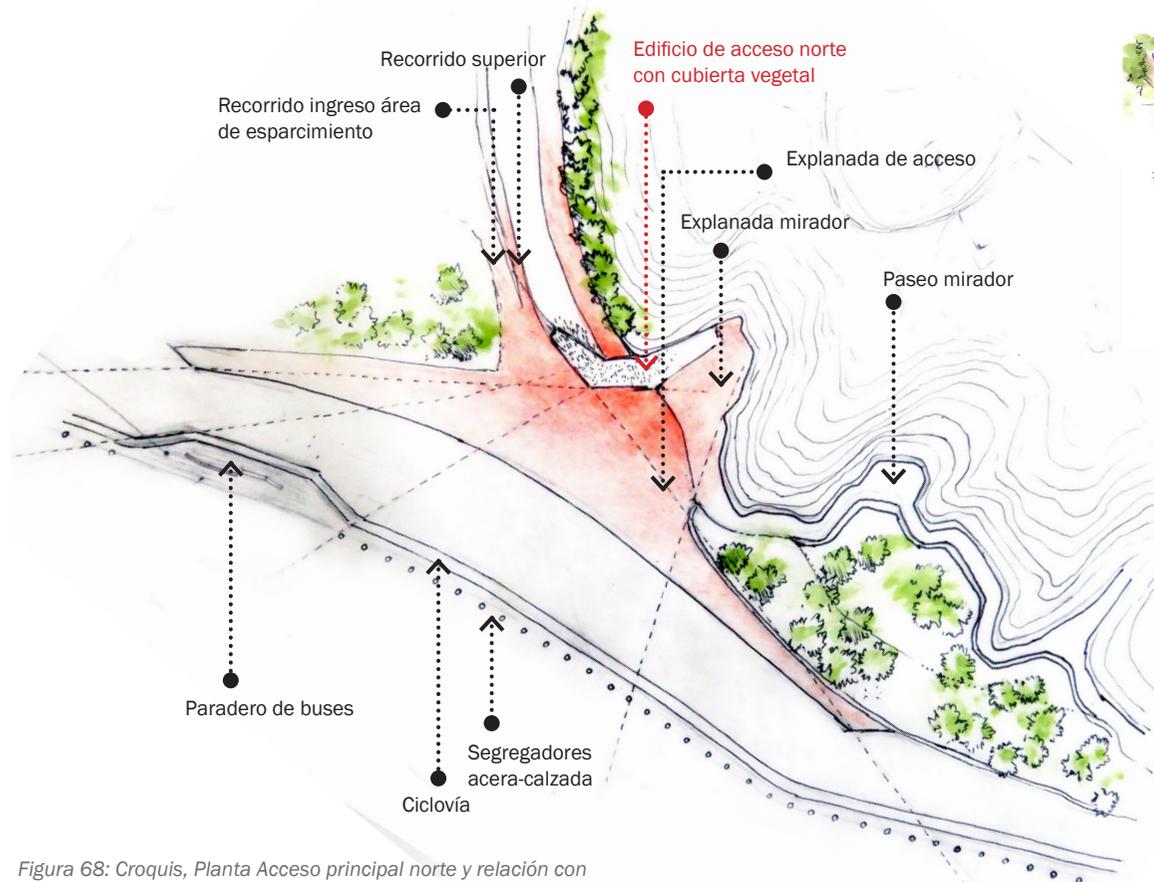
Croquis, Planta Acceso principal norte y relación con recorridos. Fuente: Elaboración propia.
